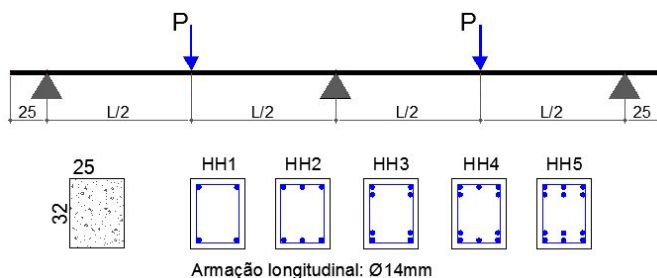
Geometria e armação longitudinal das vigas ensaiadas por Leonhardt e Walther (1962)
